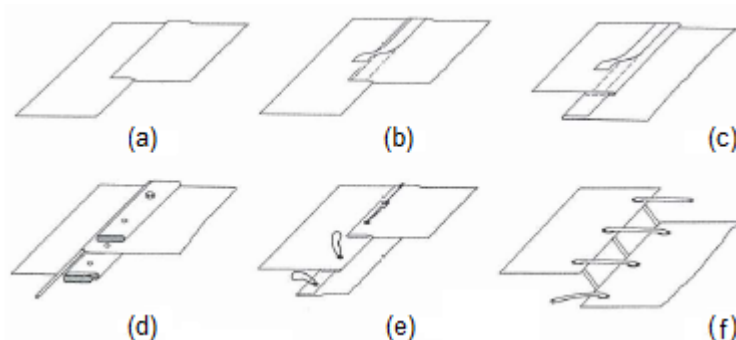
Tipos de ligações de superfície (a:junta soldada; b:junta costurada; c:junta costurada com aba; d:ligação em chapa metálica; e:ligação cordoada; f:ligação entrelaçada)
